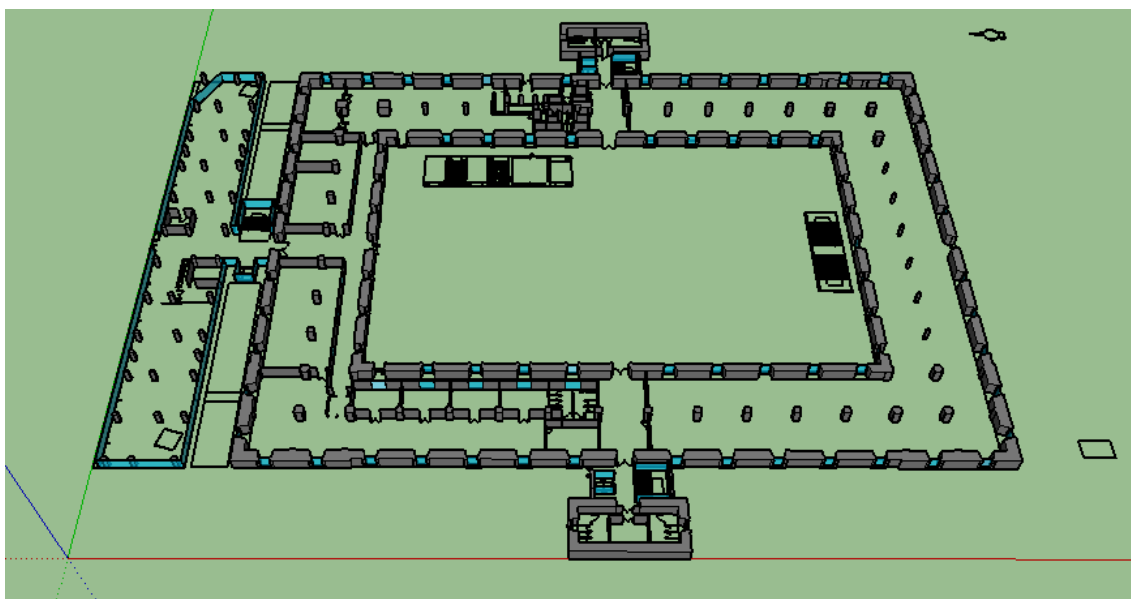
Plano Planta Baja del edificio CIM mostrado en SketchUp
